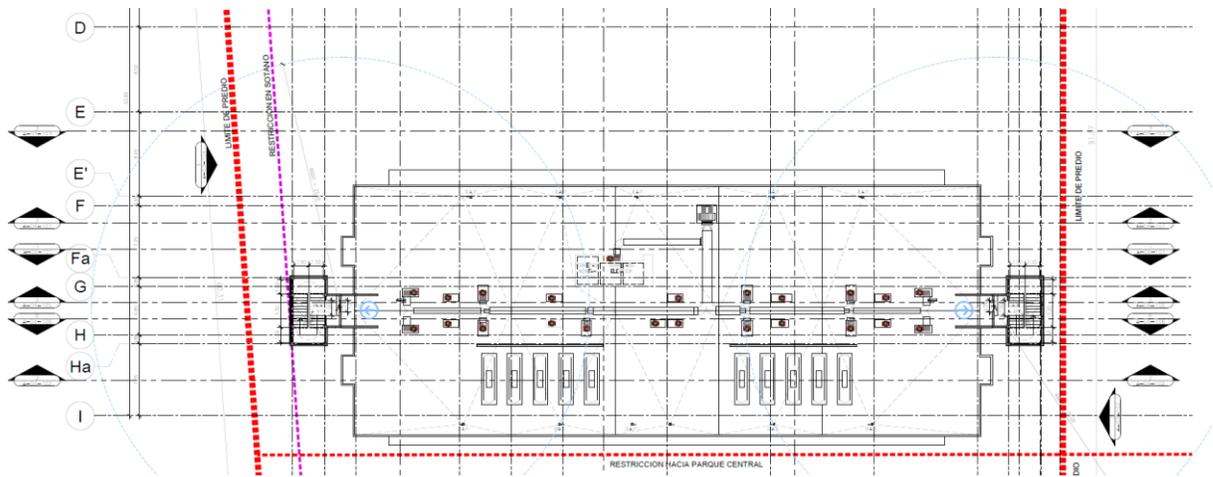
PLANTA NIVEL 15 AZOTEA.
